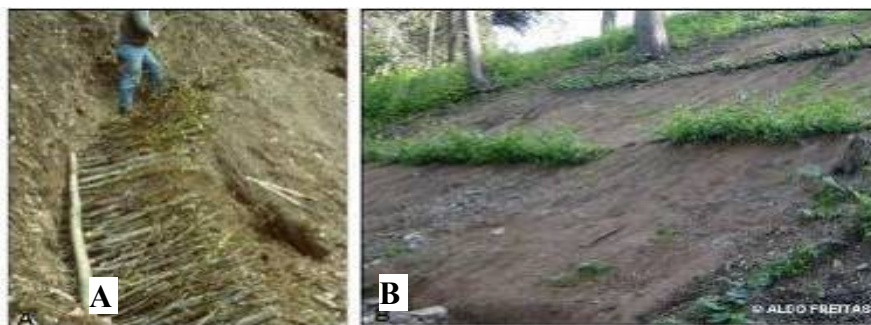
Técnica de implantação da faixa de vegetação. A- fase de construção e B- fase final (Lucena, 2006).
